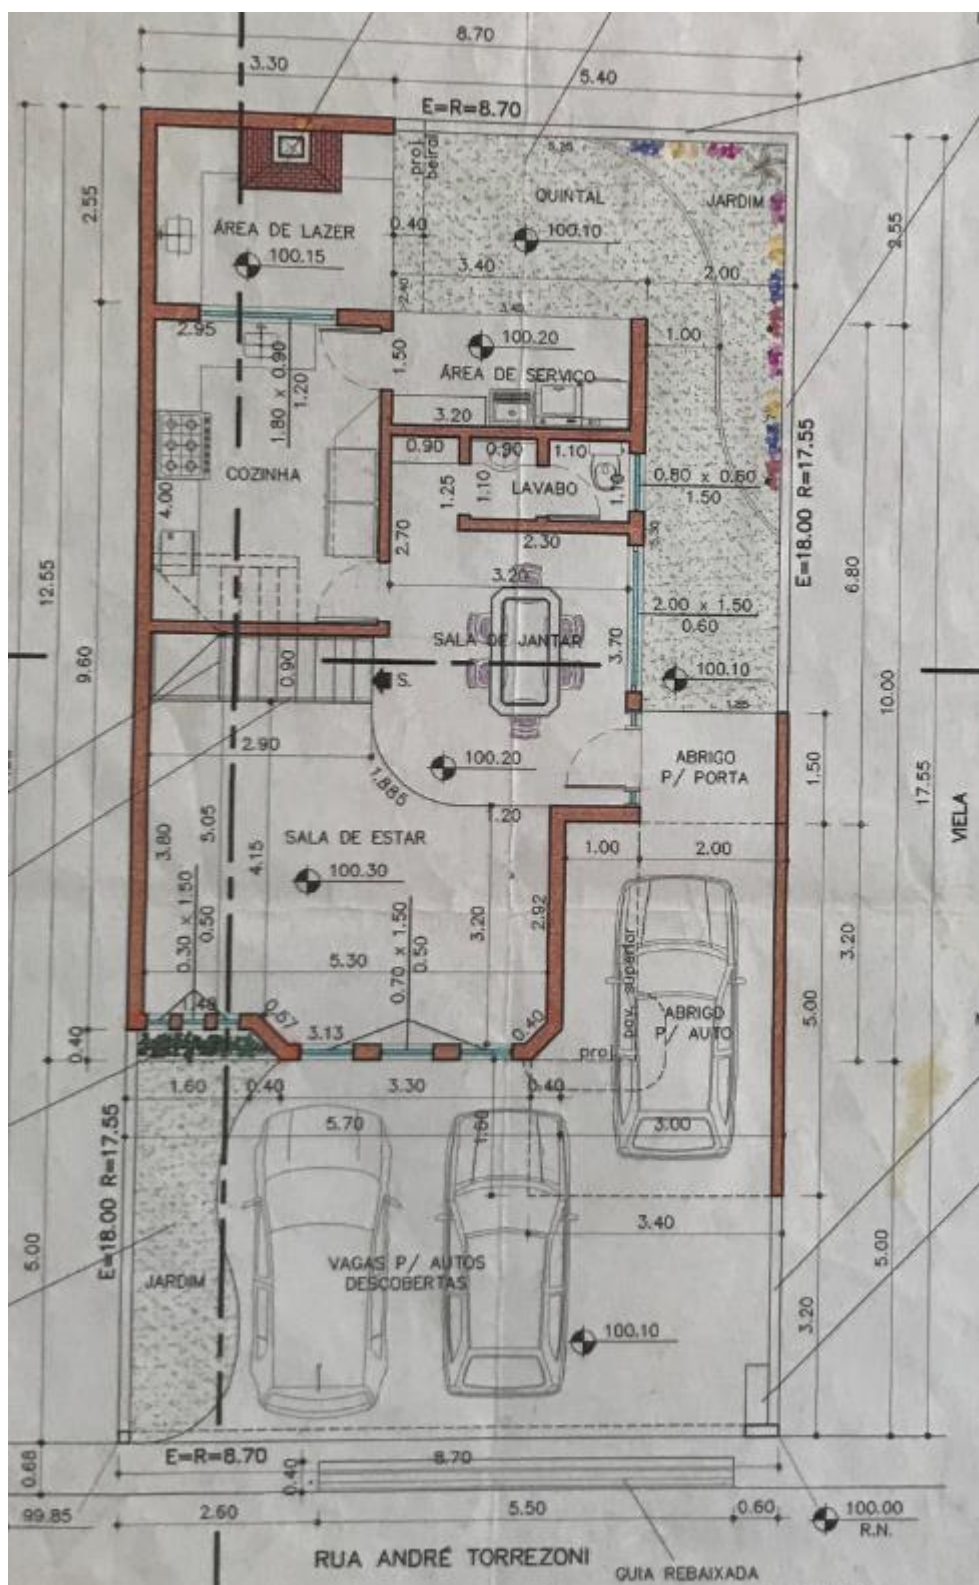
Planta do pavimento térreo do imóvel paradigma.
